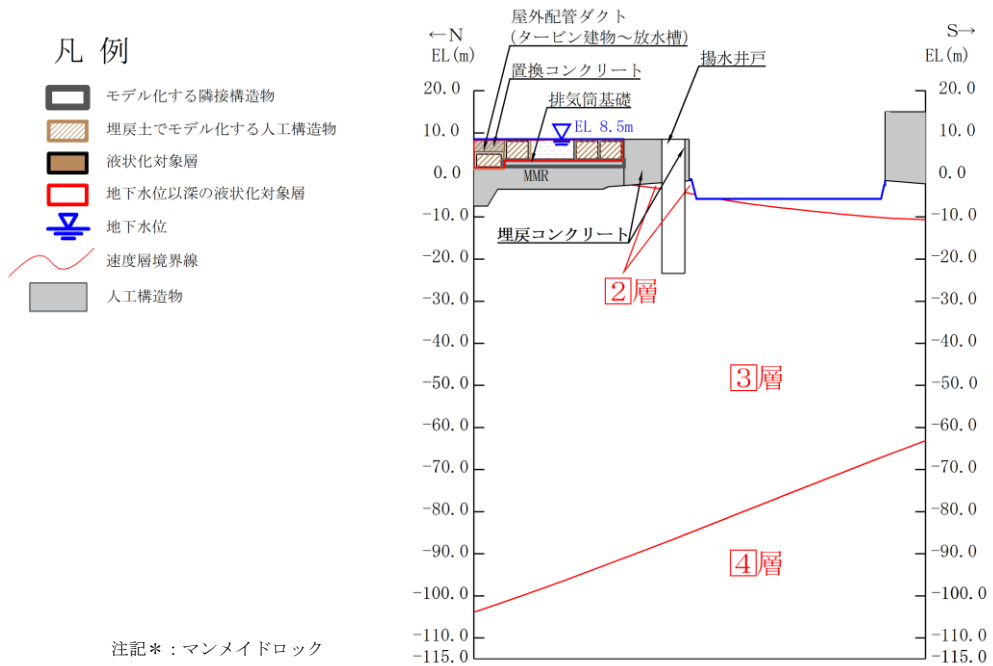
評価対象断面図 (B-B 断面 (南北方向))
